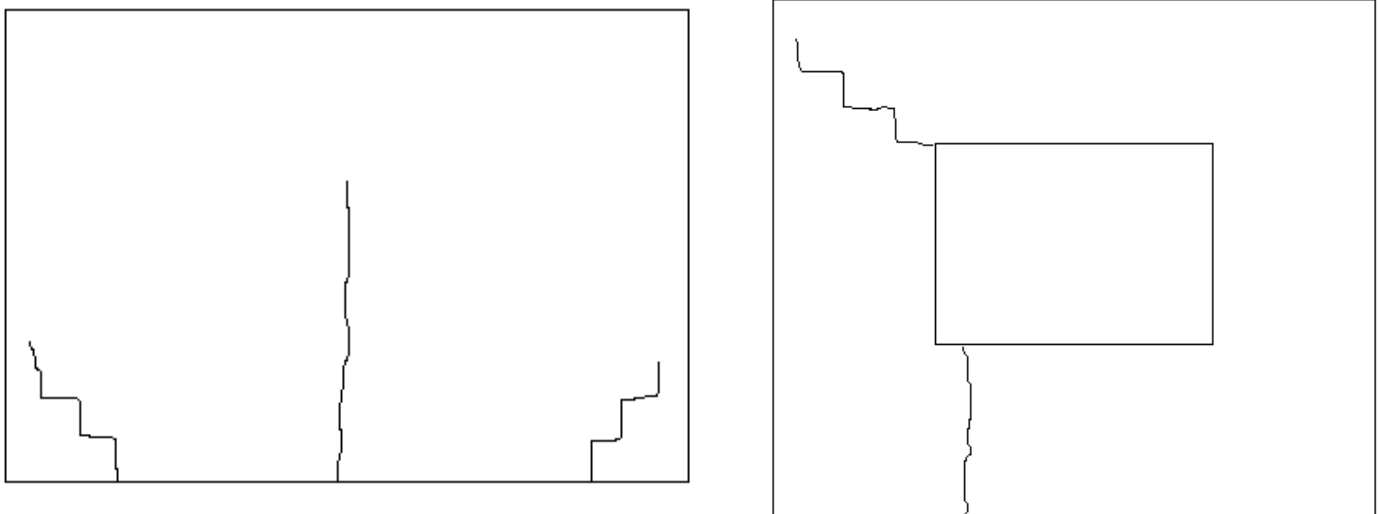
Formas características de fisuras en mampostería por asentamiento diferencial de fundación.
